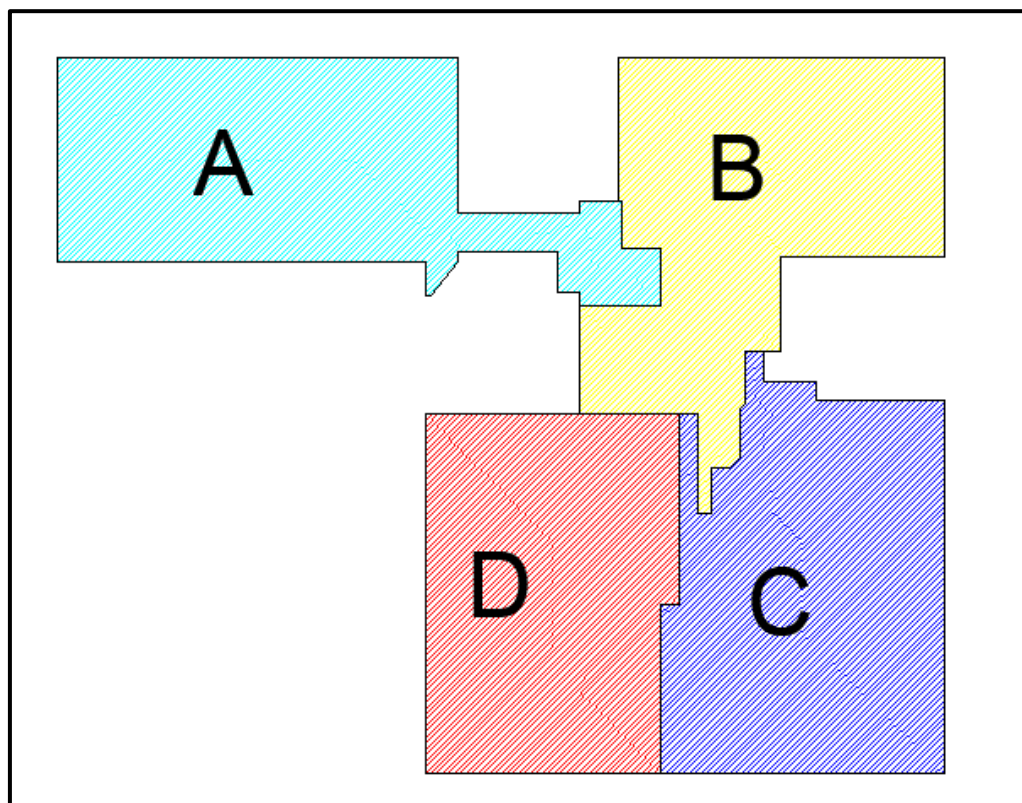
Sectorización de planta típica. (Piso 3, 4, 5 y 6) Fuente: Propia
